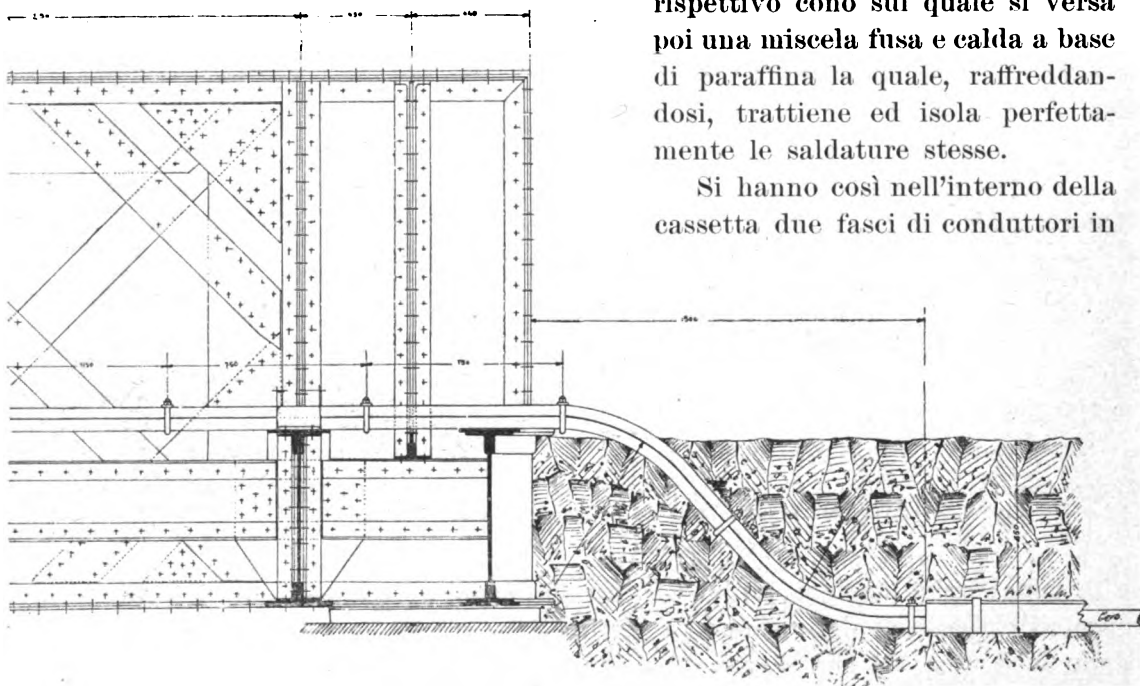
Attraversamento su un ponte in ferro (Sezione longitudinale).
